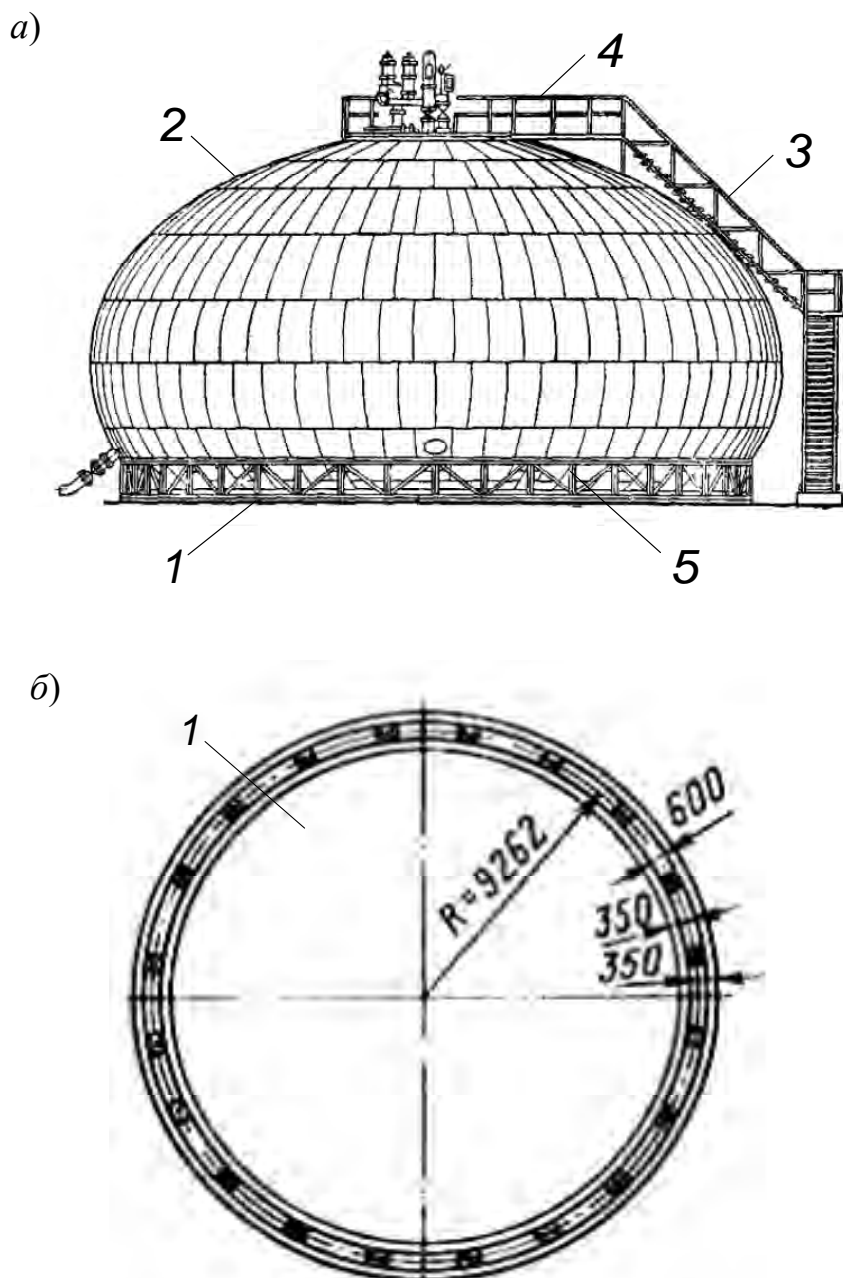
Каплевидный резервуар с опорным кольцом: а – боковой вид; б – план; 1 – днище; 2 – корпус; 3 – лестница; 4 – площадка с оборудованием; 5 – опорное кольцо
